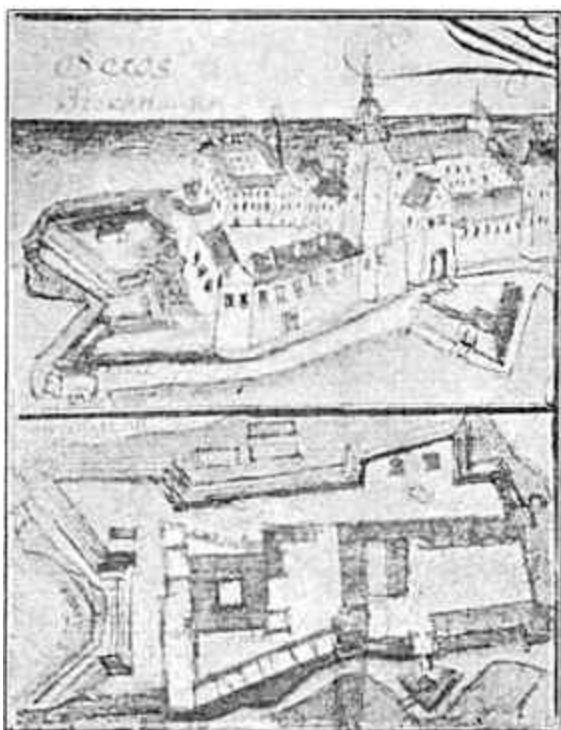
Burg Fischhausen, Grundriß und Ansicht (v. Collas).
